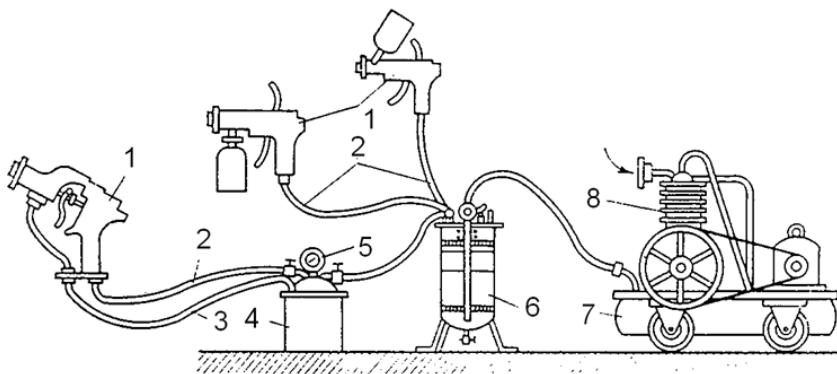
Пересувний фарбувальний агрегат повітряного розпилення
